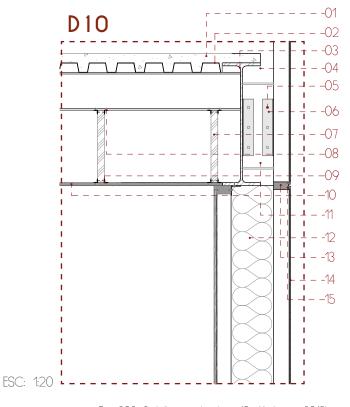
Detalle constructivo 10. (Autoras, 2019)
